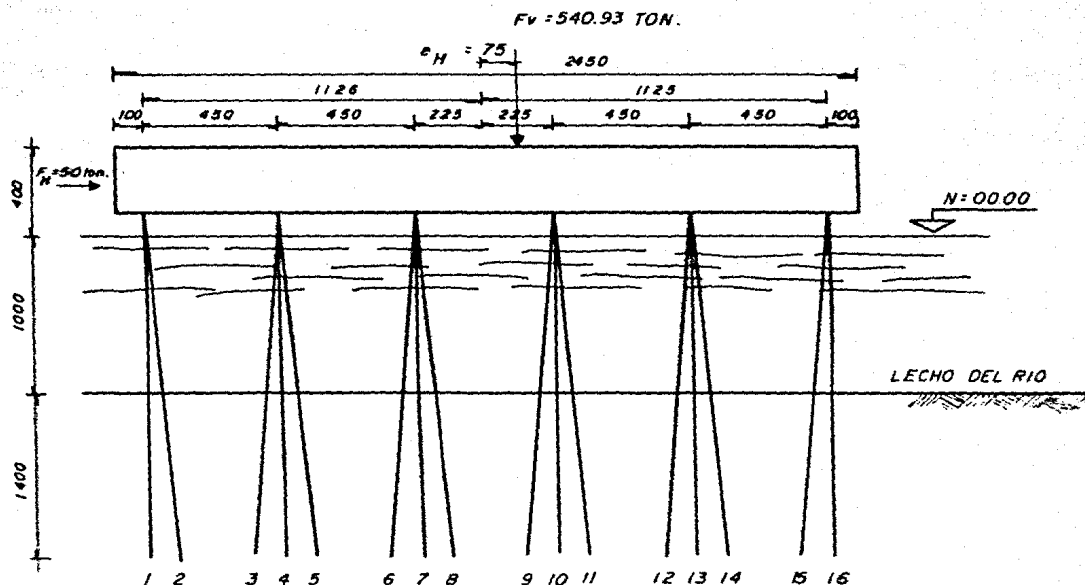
DISTRIBUCION TRANSVERSAL TIPICA DE PILOTES
